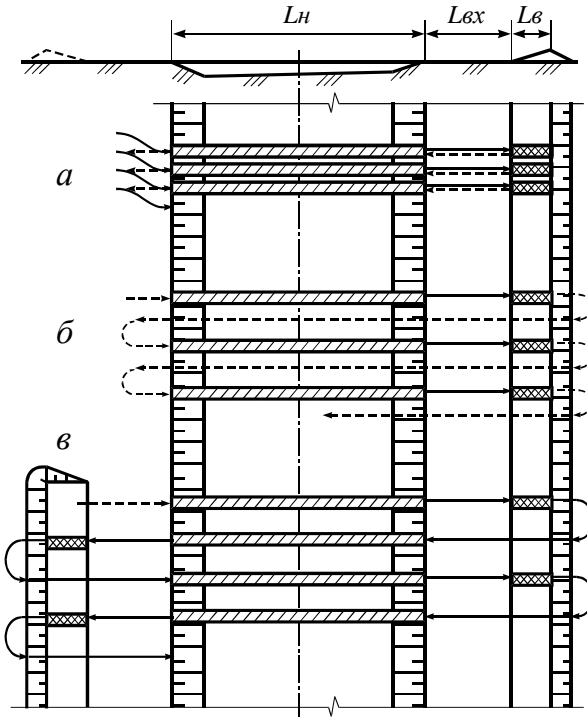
Схеми поперечної розробки ґрунту бульдозером:
